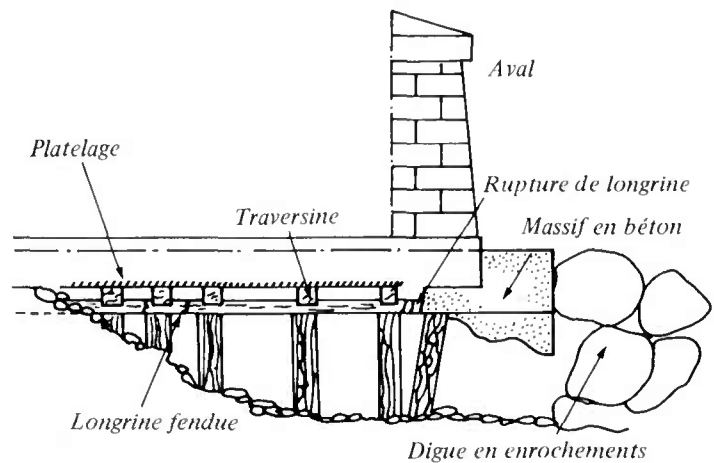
Cavité sous un massif de fondation sur pieux en bois atteignant 1,50 m de hauteur et créée par érosion régressive.
